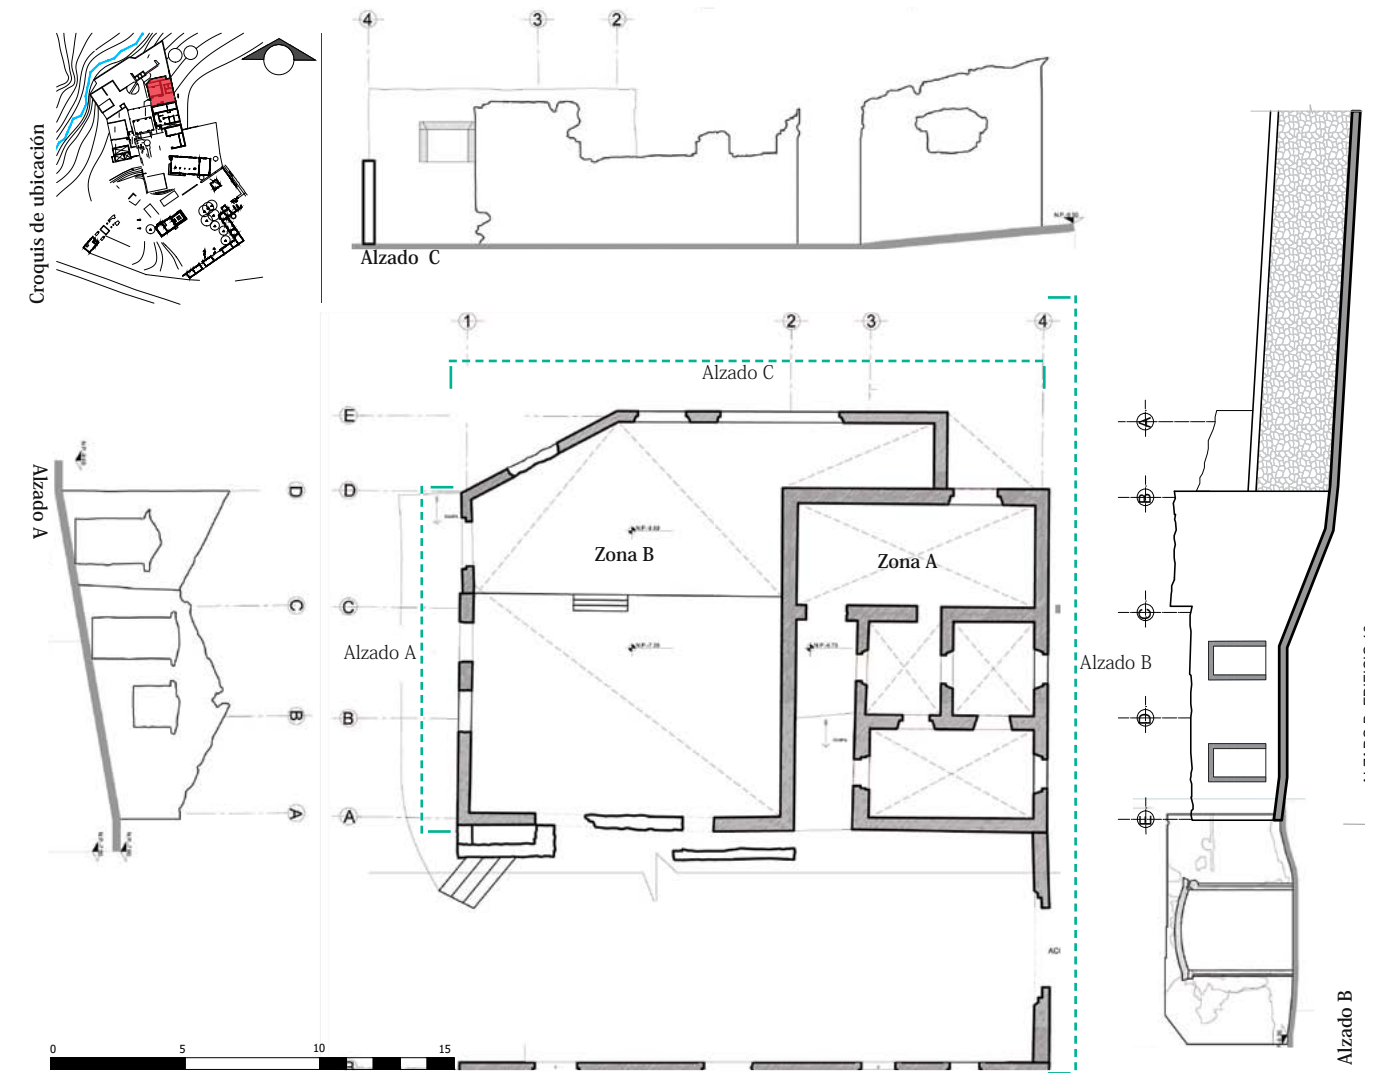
Planos del levantamiento arquitectónico del estado actual.
